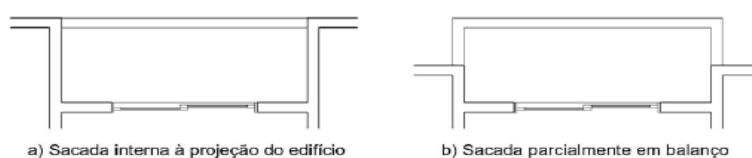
Tipos de sacadas mais apropriadas para edifícios em alvenaria estrutural.
